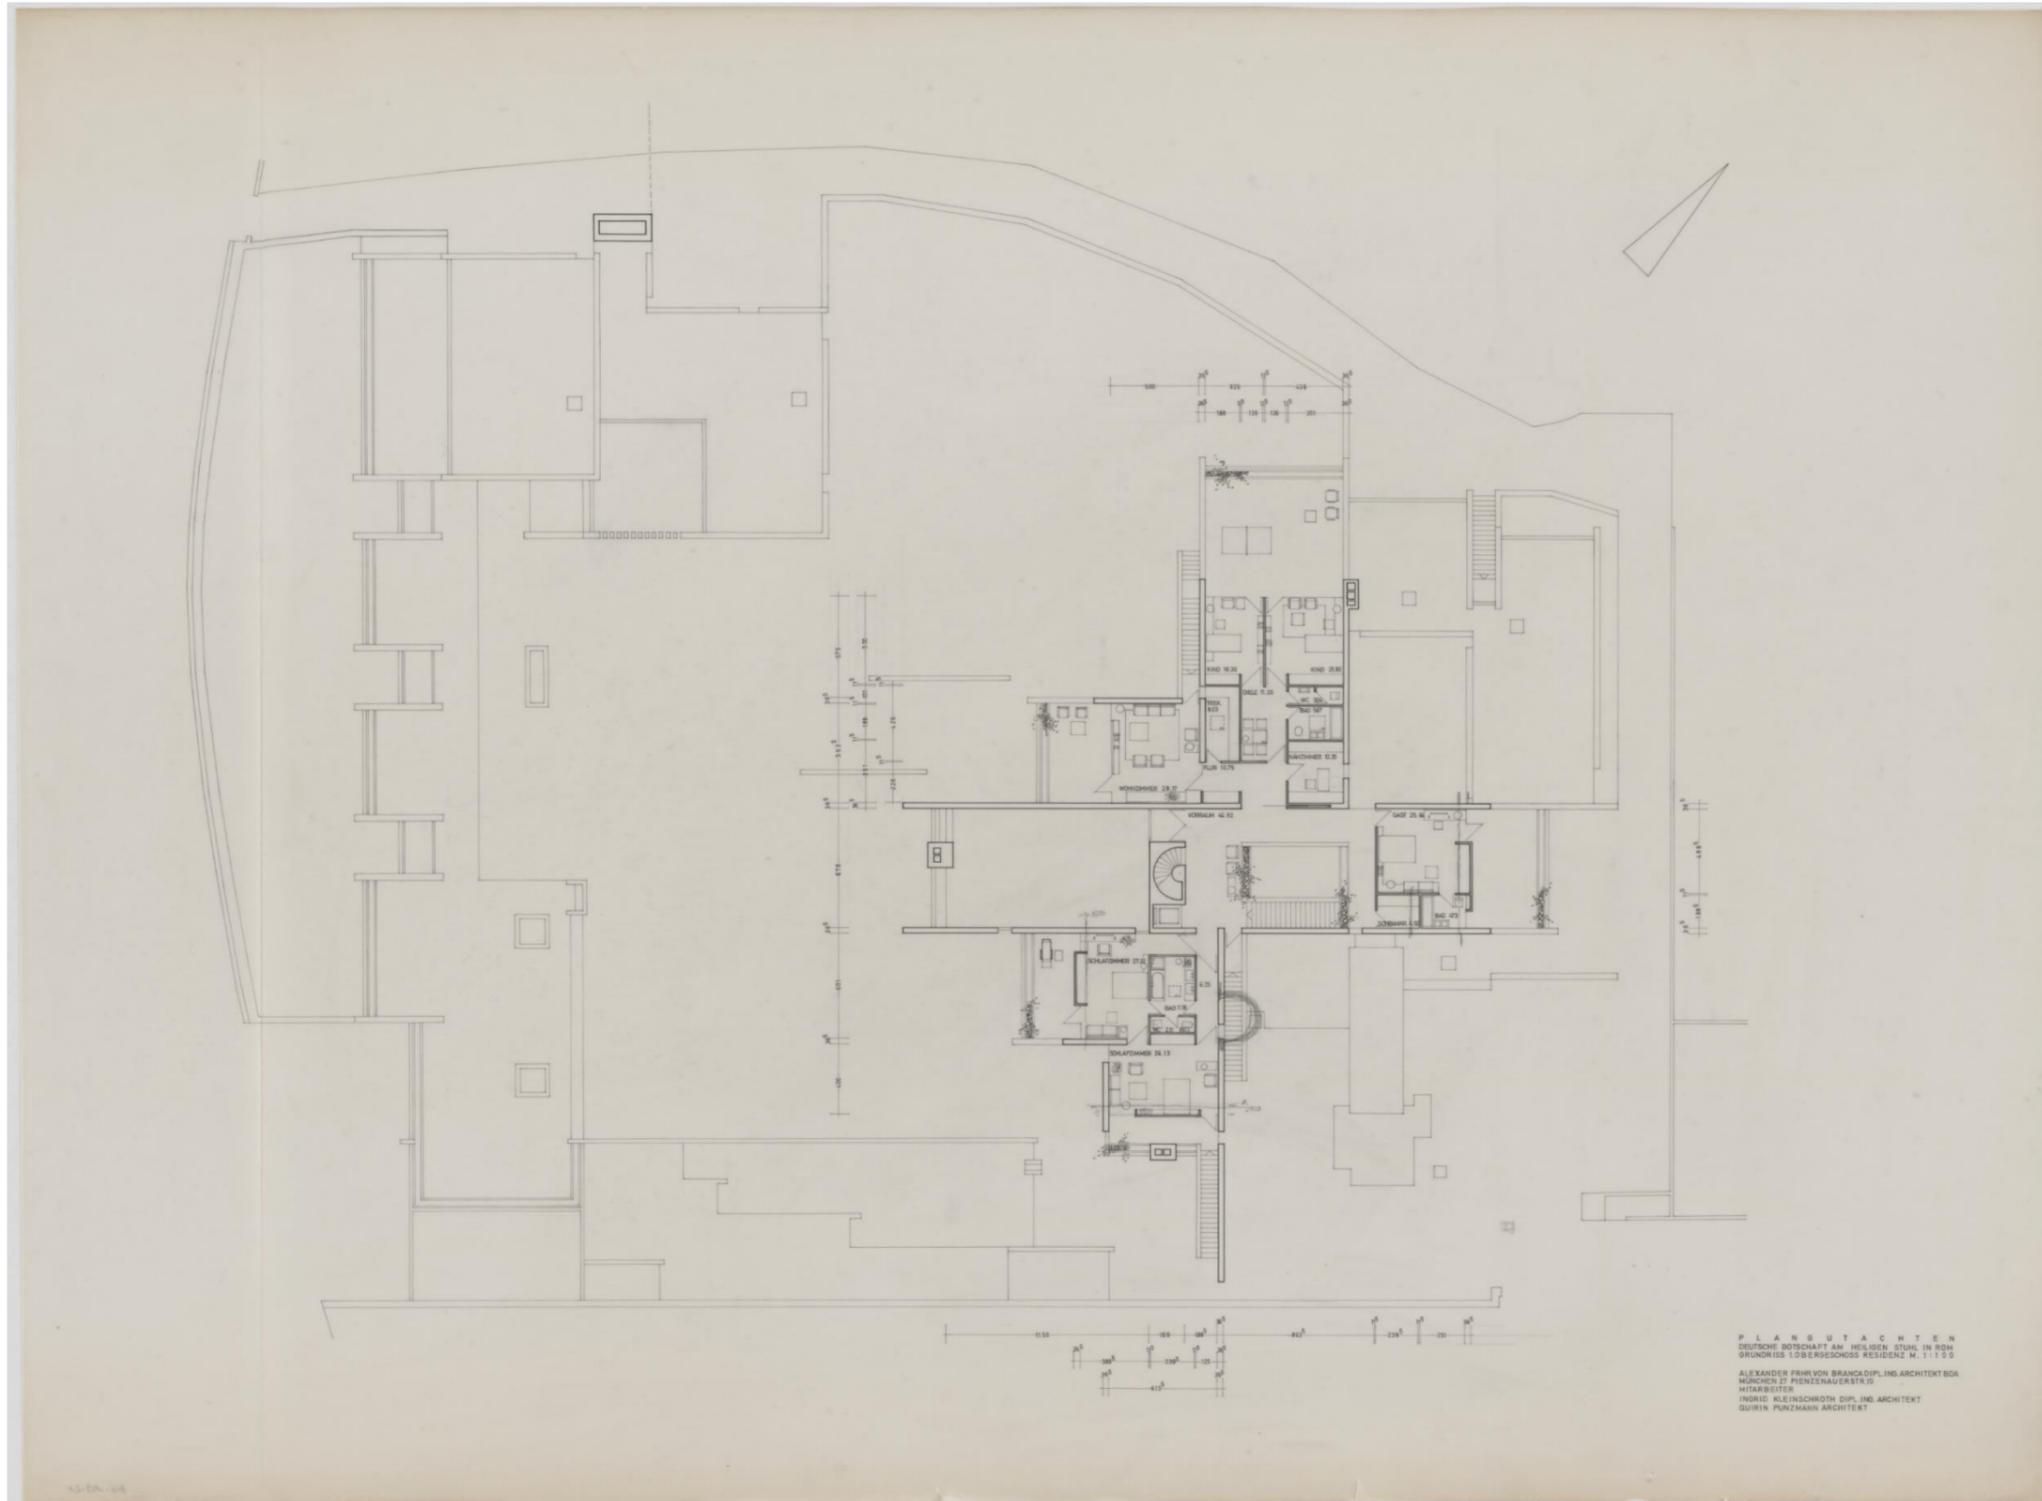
Residenz Plangutachten (Grundriss 1.OG)
